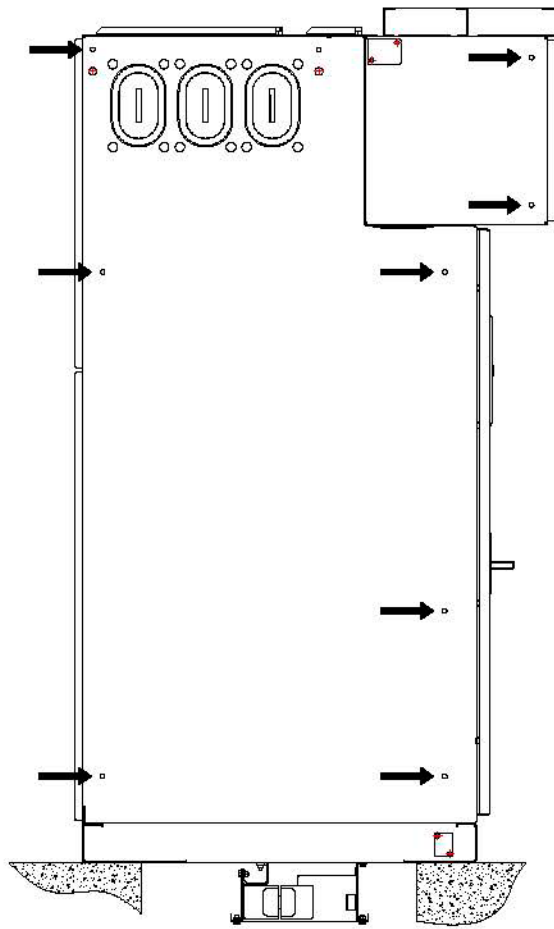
Монтаж камер КСО, сбалчивание, установка боковых закрытий
